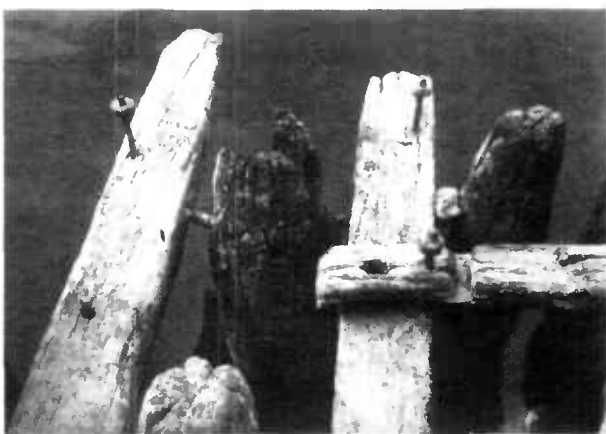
Altération des pièces métalliques d'assemblage d'un rideau et abrasion des pièces de bois.
